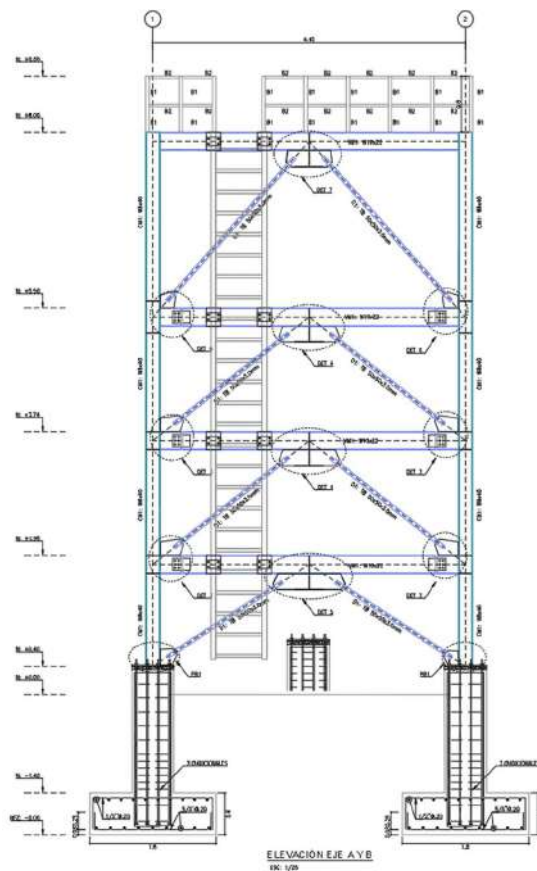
Elevación de estructura metálica para instalación de radar SOPHY.
